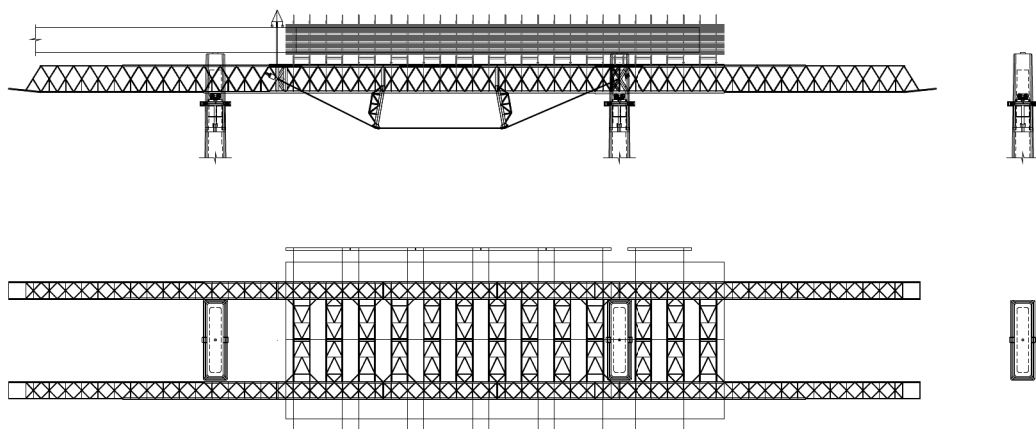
Autocimbra bajo tablero para construcción de vanos de 62 m de luz
